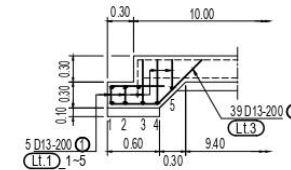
BBS Outlet Spillway Daftar Tulangan dan Potongan Bengkokan Lantai Kanan
